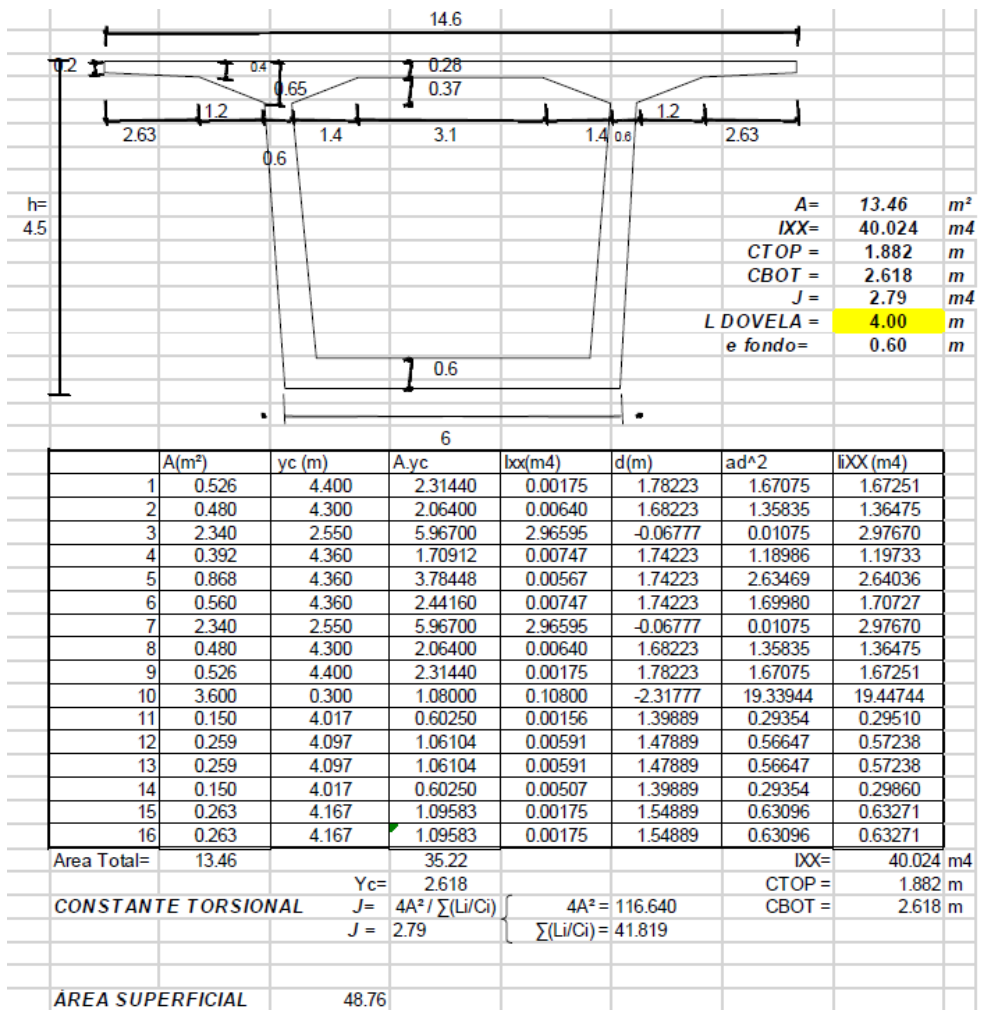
Dimensiones y propiedades de la viga cajón eje de columna puente San Pedro.
